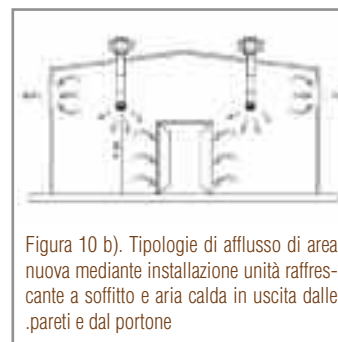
b). Tipologie di afflusso di aria nuova mediante installazione unità raffrescante a soffitto e aria calda in uscita dalle pareti e dal portone
